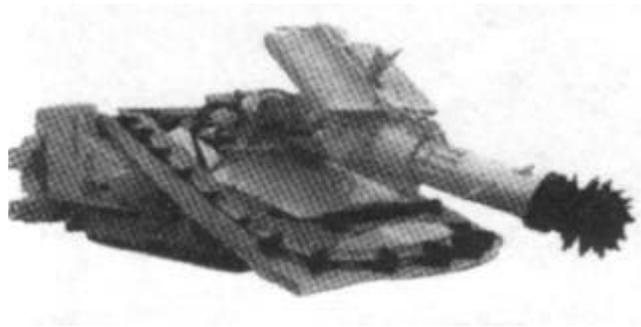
Rozadora (Milling), carga de escombros de carrusel con paleta
